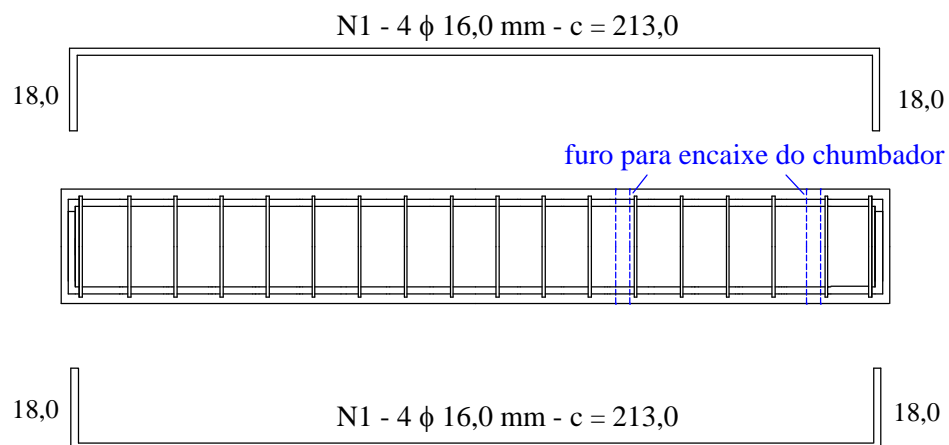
Modelo utilizado no ensaio da ligação viga-pilar (dimensões em cm).
